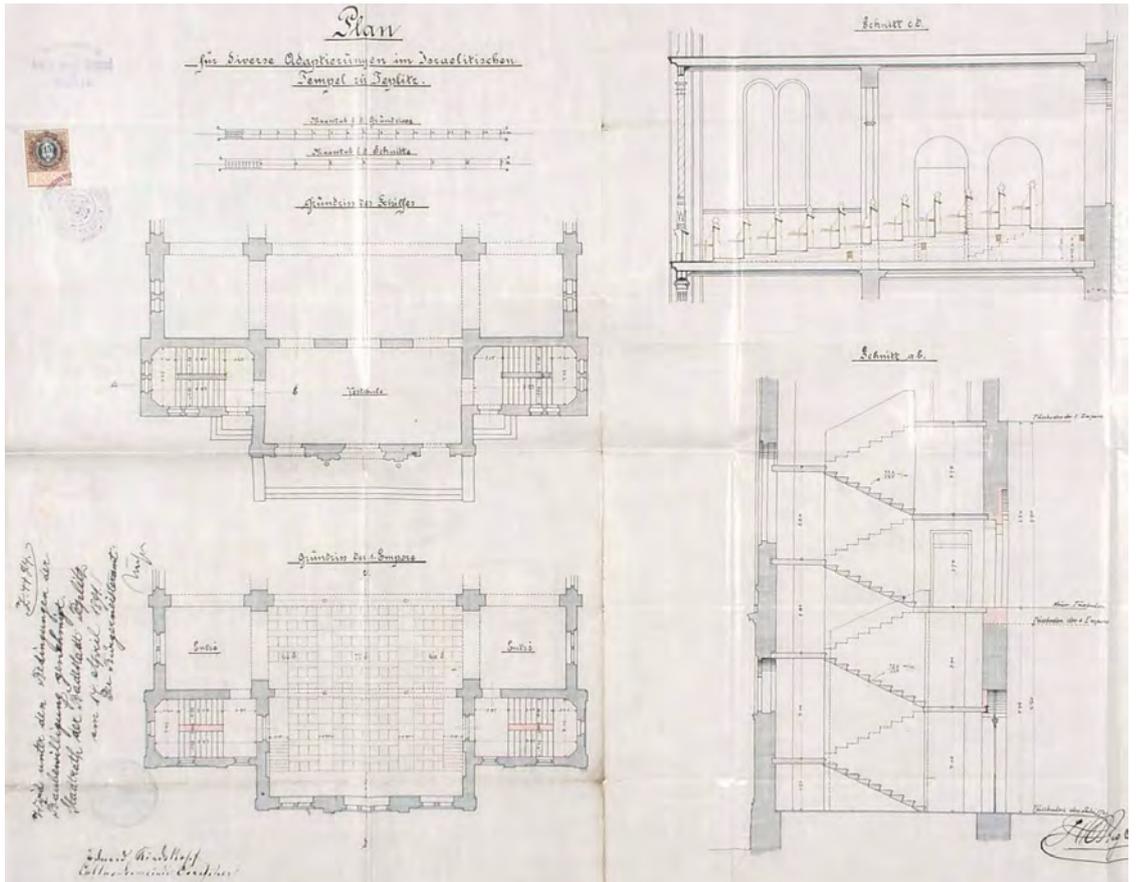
Plan zum Umbau der ersten Frauenempore, 1891
